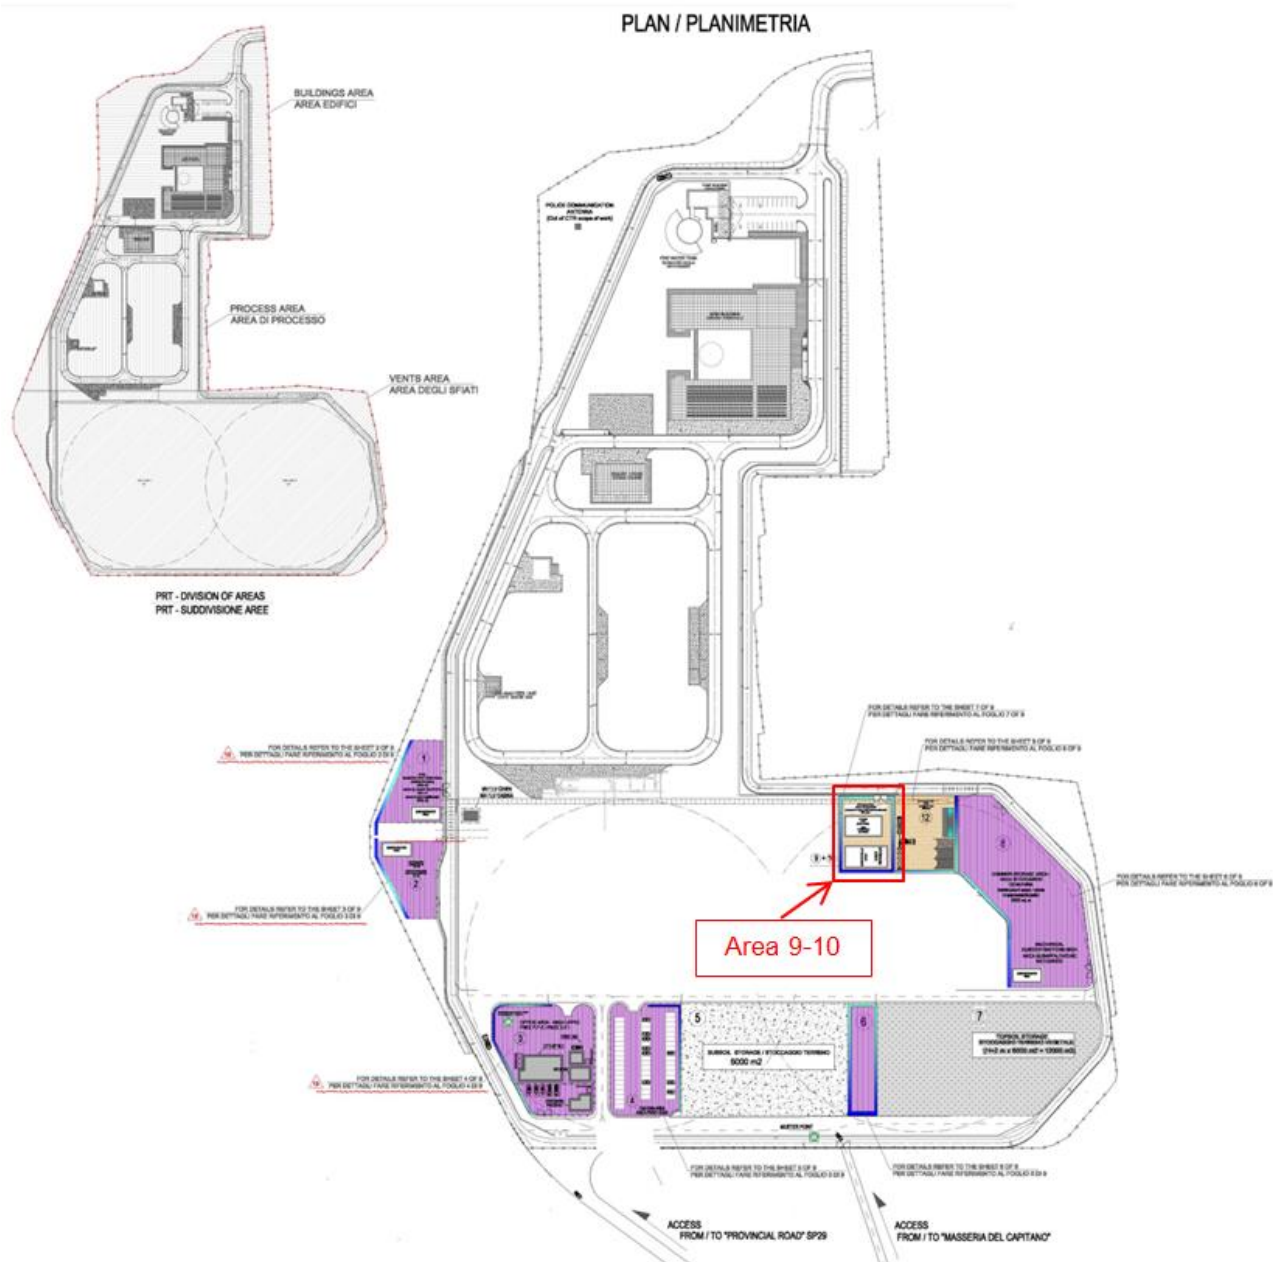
Layout dell'area di cantiere del PRT con indicazione dell'area 9-10 adibita al deposito temporaneo dei rifiuti
